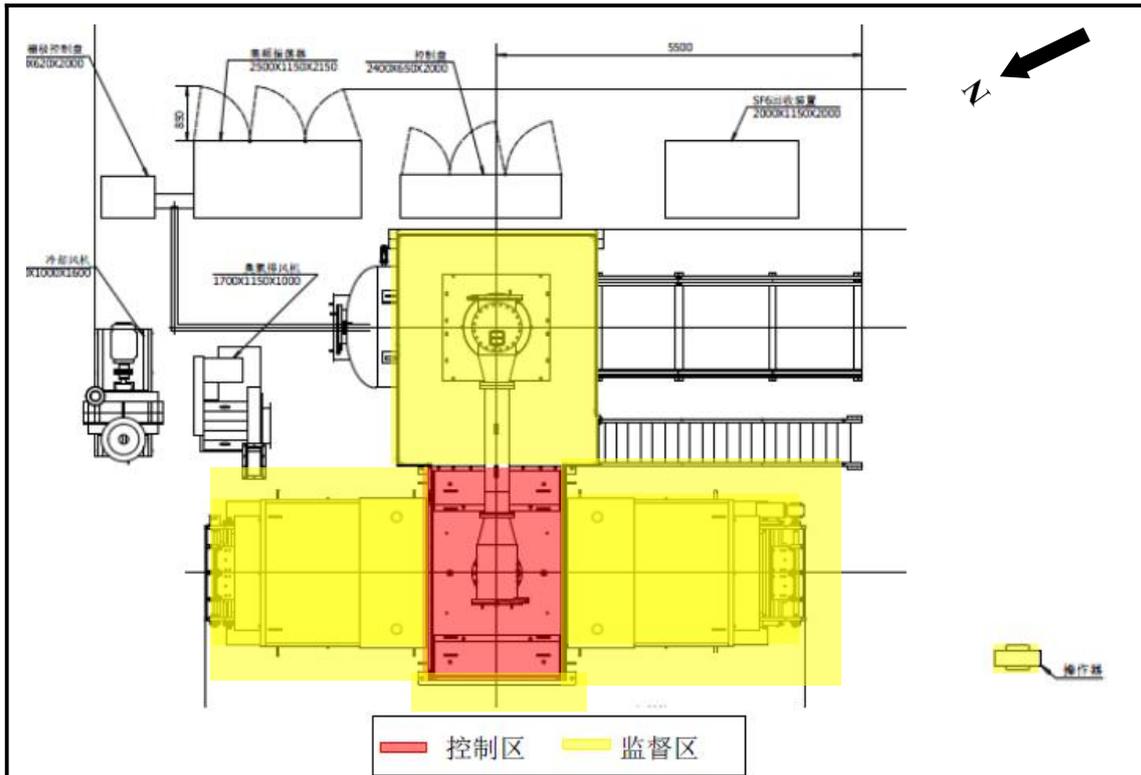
电子加速器辐照设备辐射工作场所平面布置图
